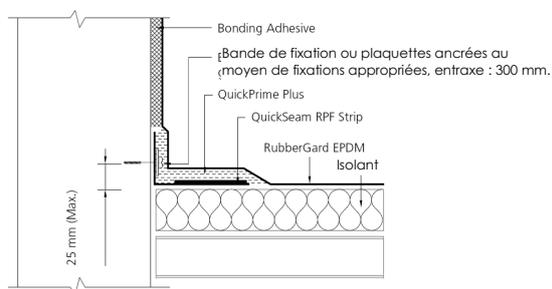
Fixation au droit de l'angle du relevé au moyen d'une bande QS RPF Strip
